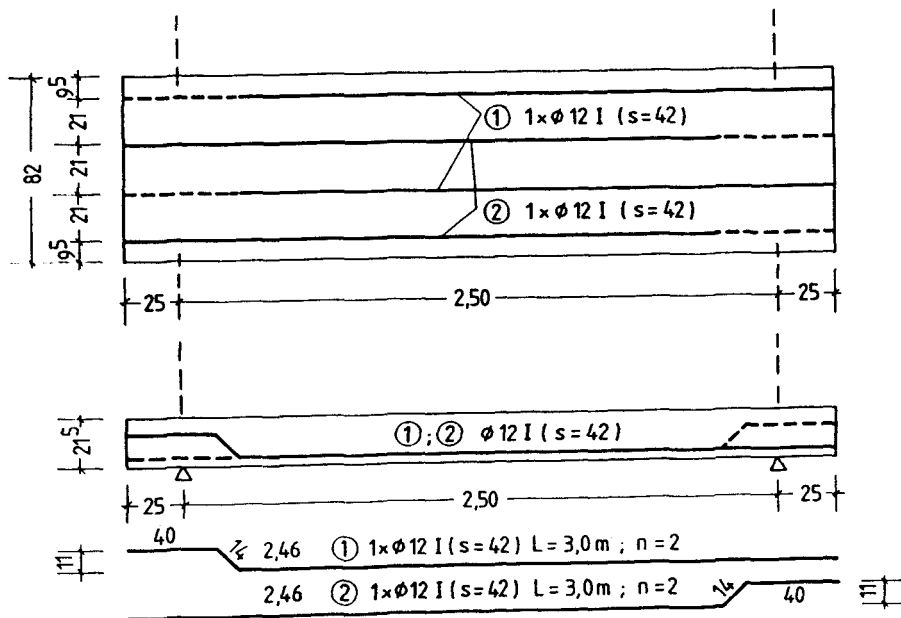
Bewehrungspläne der unverstärkten Stahlsteindecken
